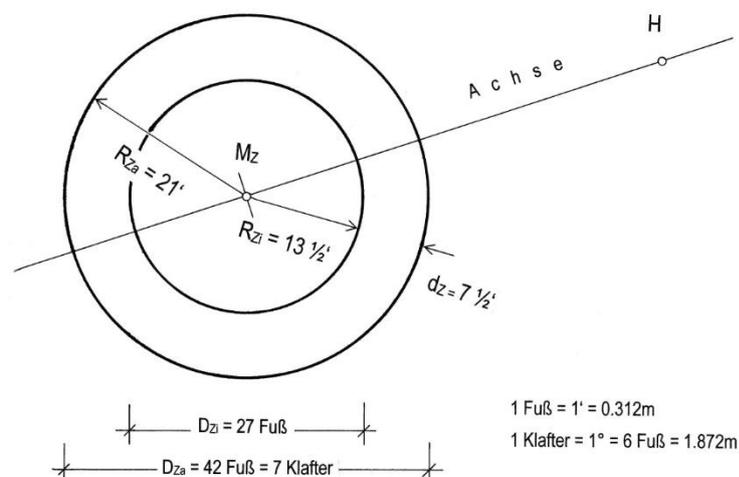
Rundkapelle Starhemberg, Grundriss Zentralbau mit Abmessungen (Soll-Werte)
